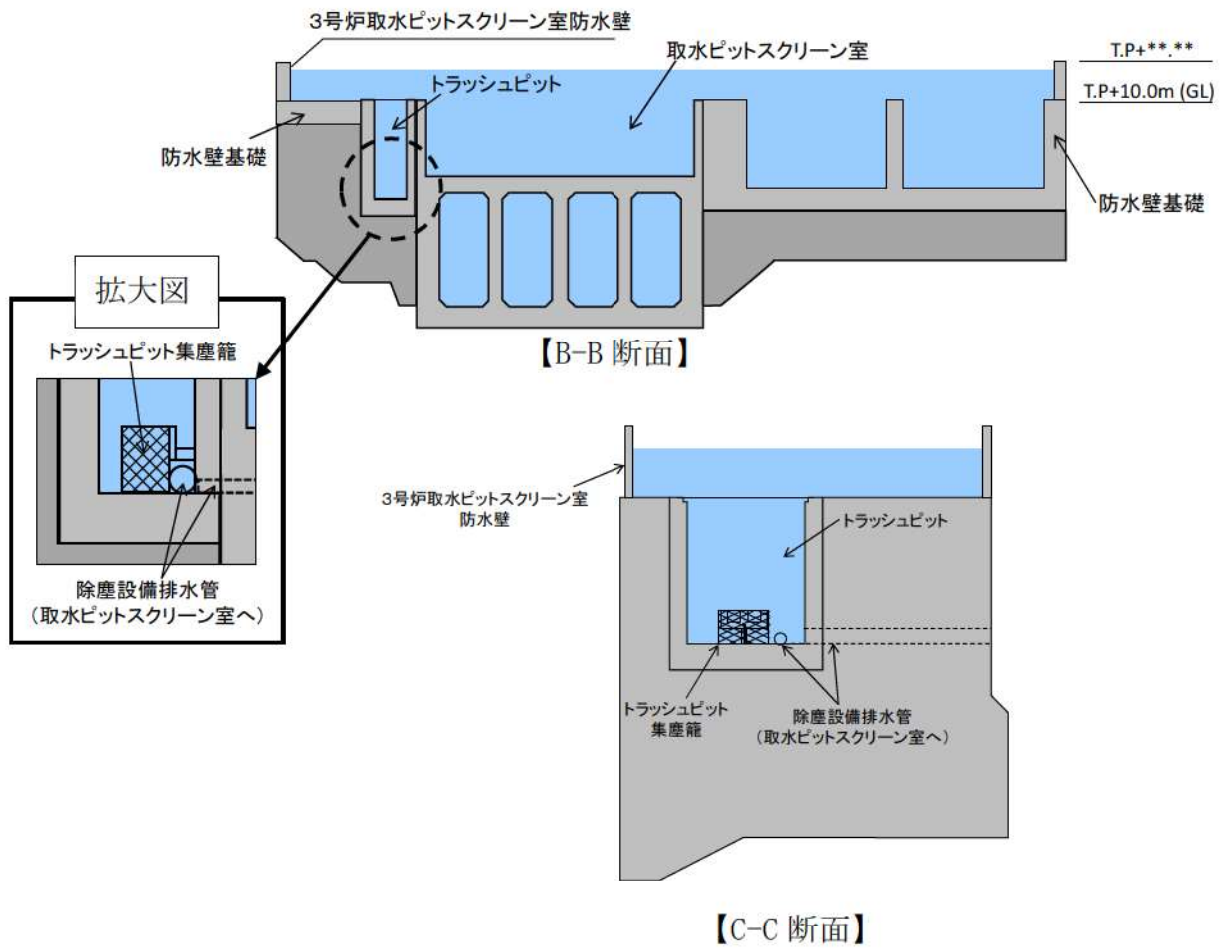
3号炉取水系統 流入対策配置図 (B-B, C-C 断面)
